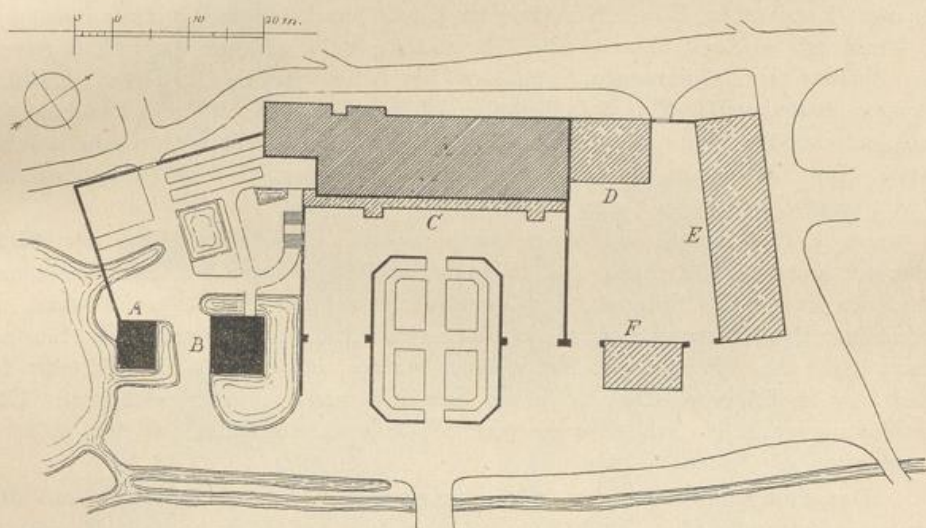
Schloss Gimborn. Lageplan aus dem J. 1804.
